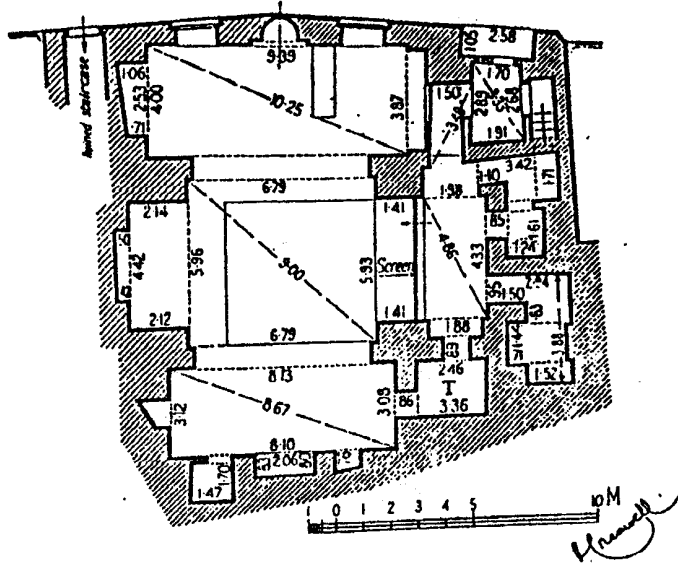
مسقط أفقي لمسجد مصطفى بك بن بنت غزال المعروف
